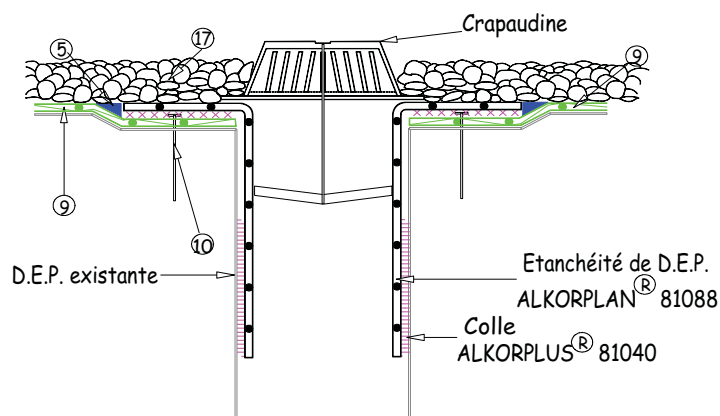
Etanchéité préfabriquée de descentes d'eau pluviale
